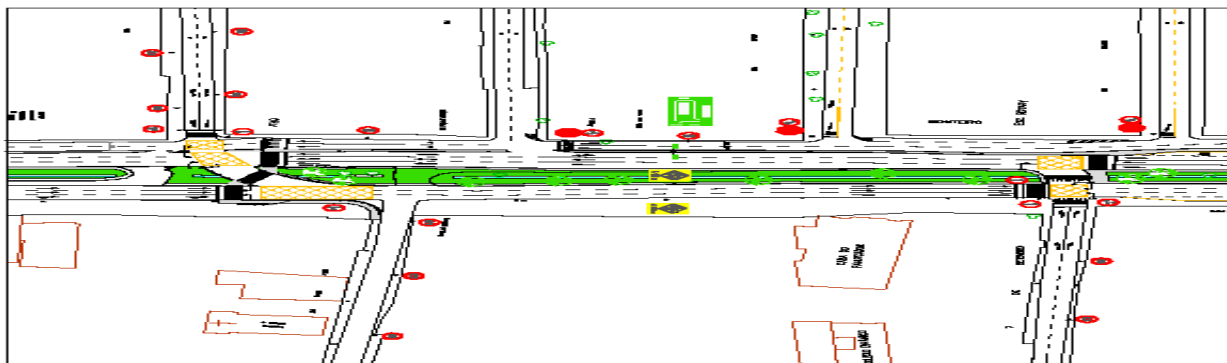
planta baixa do projeto – trecho Bomba da Marieta – Situação Proposta.
